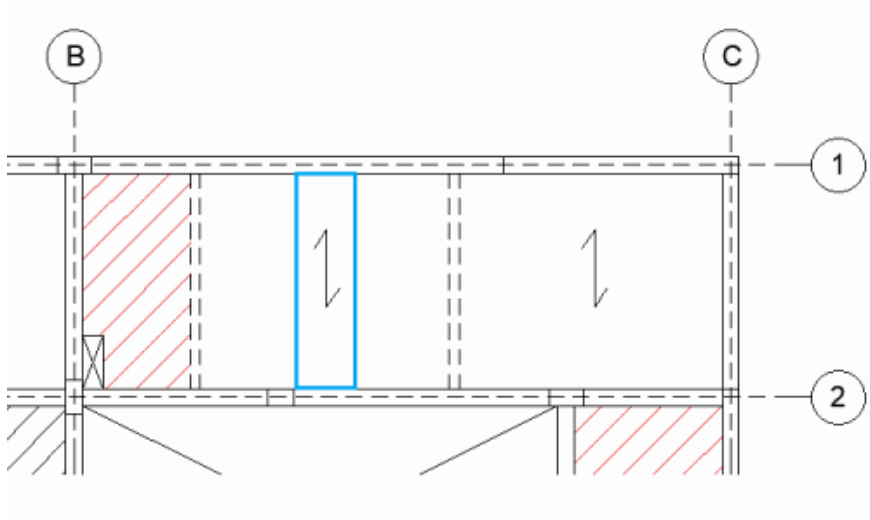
1. Ubicación de vigueta en el encofrado de techo típico
